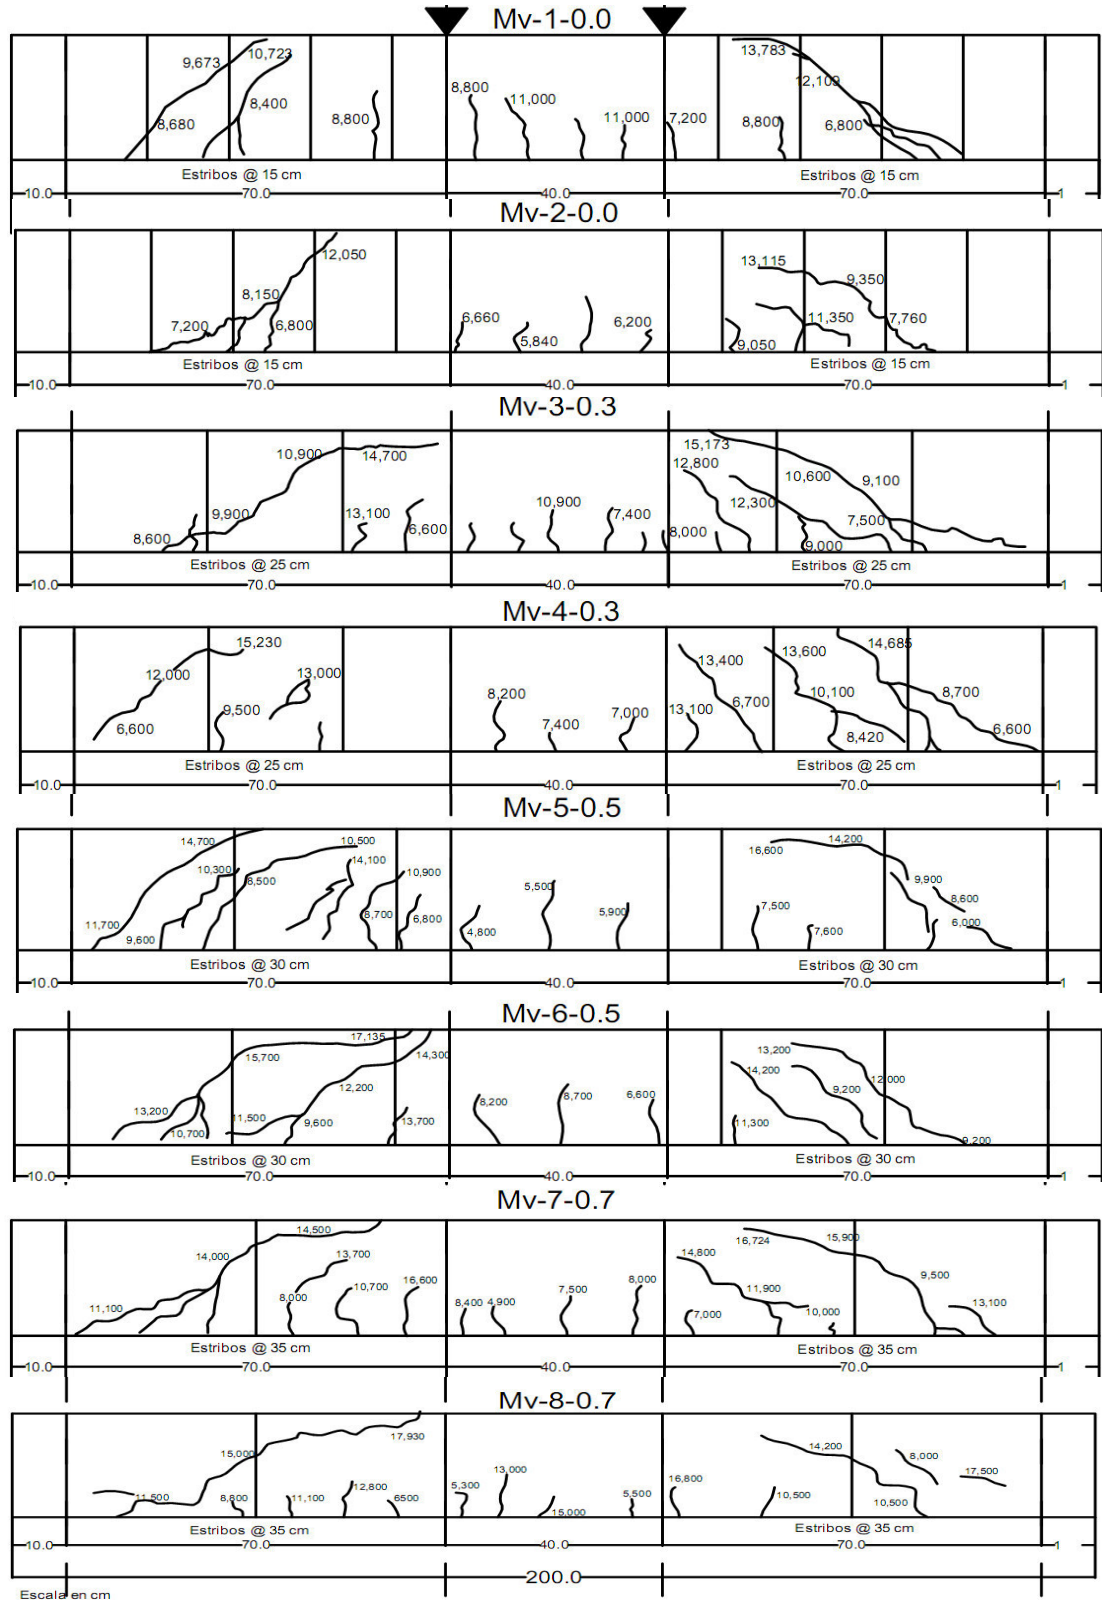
Patrón de agrietamiento para las vigas reforzadas transversalmente con fibras y estribos para la relación (a/c) 0.55.
